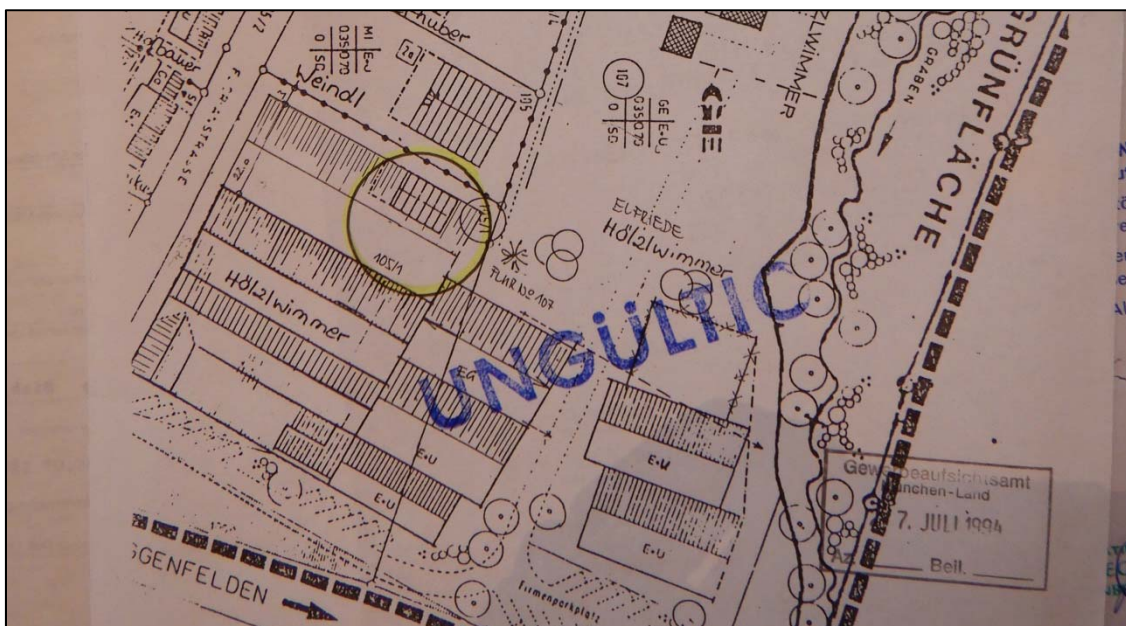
Auszug aus dem Lageplan zum Eingabeplan zum Bauvorhaben gemäß /47/
